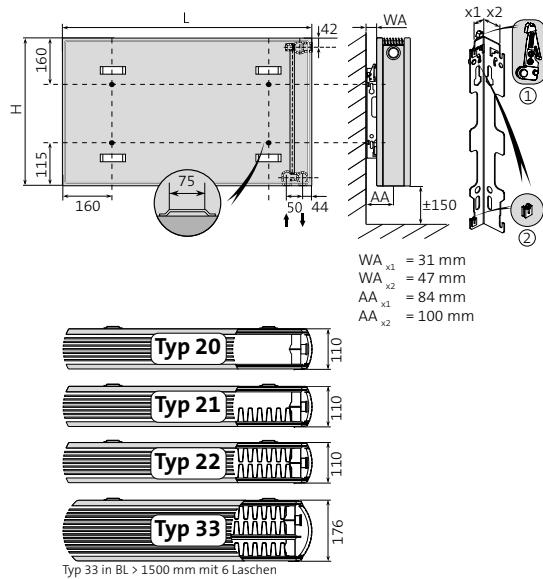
Abmessungen und Befestigung Kos H und Faro H;
